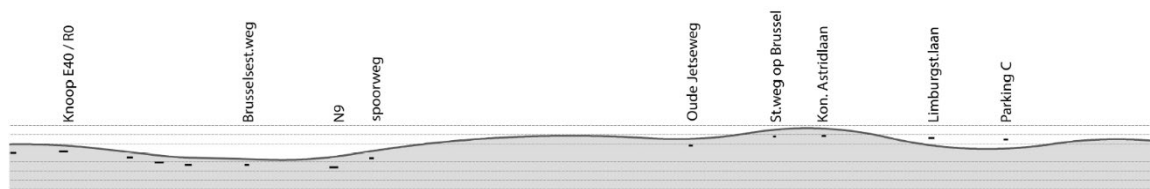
Profil longitudinal existant dans la zone de Wemmel
